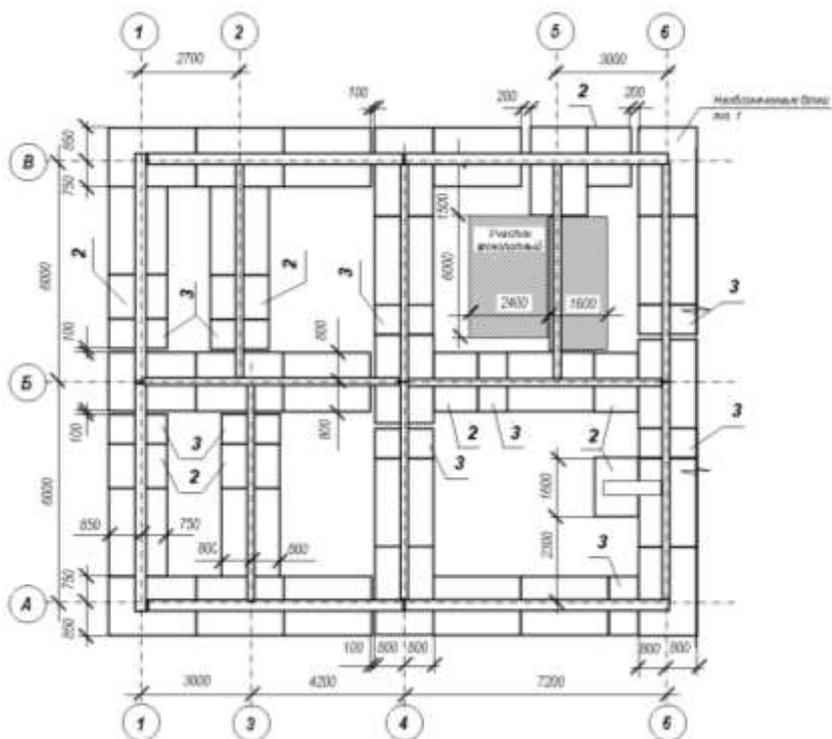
Пример оформления схемы расположения элементов ленточных фундаментов жилого дома
